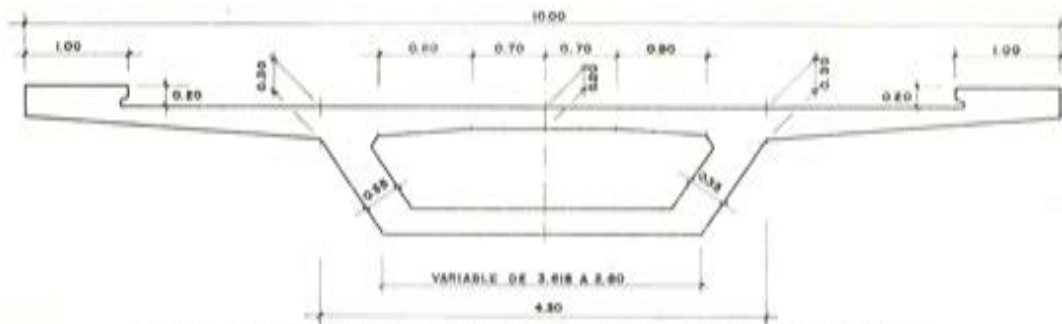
Paso del Real Automóvil Club y San Agustín (sección transversal).
